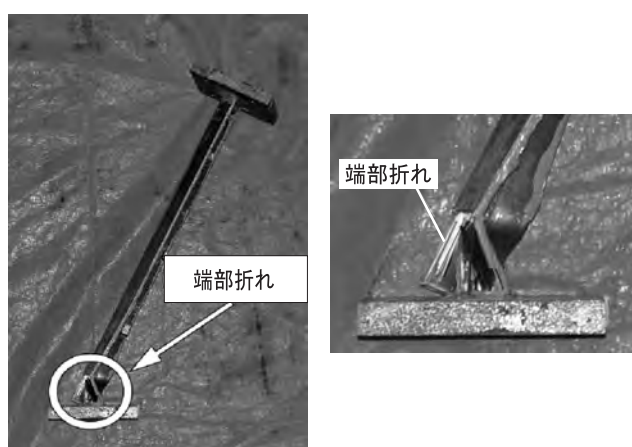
比較的短い試験体の破壊性状 (L50-08C 試験体)
